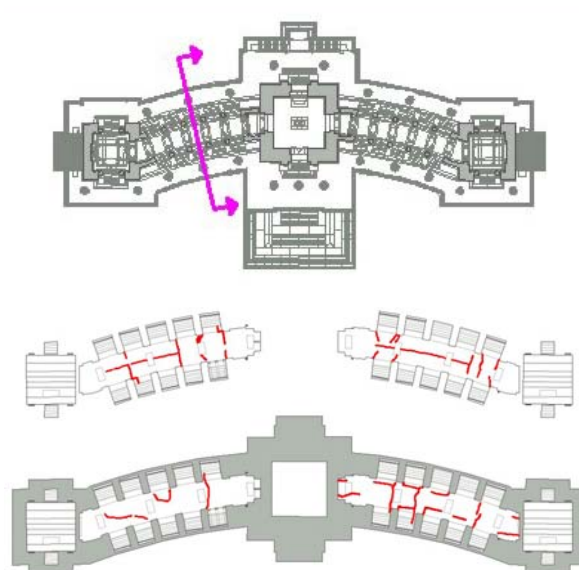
Proiezione della volta e pianta della galleria dello stilobate: quadro fessurativo.
